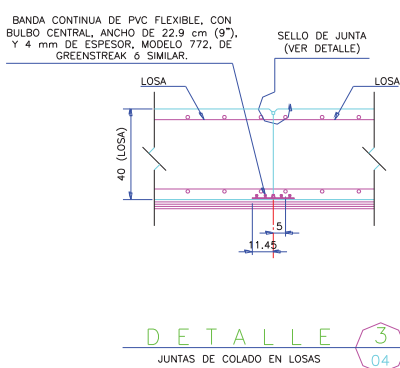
Detalles de la colocación de las bandas de P.V.C en las juntas de construcción.
